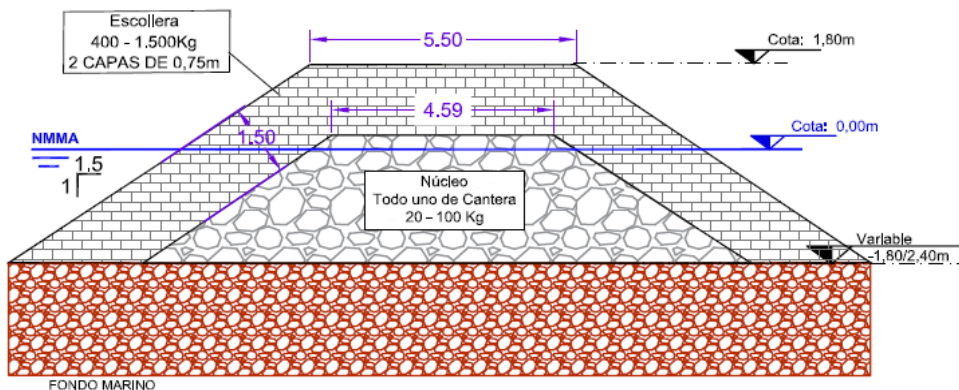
Sección de espigón coronado a 1,80 m sobre NMM
